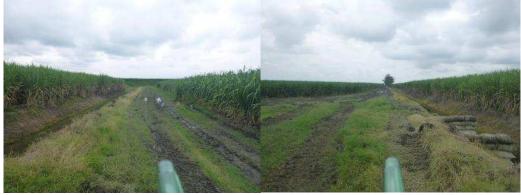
Canal de conducción Vista atrás (izquierda) y Vista adelante (derecha)
